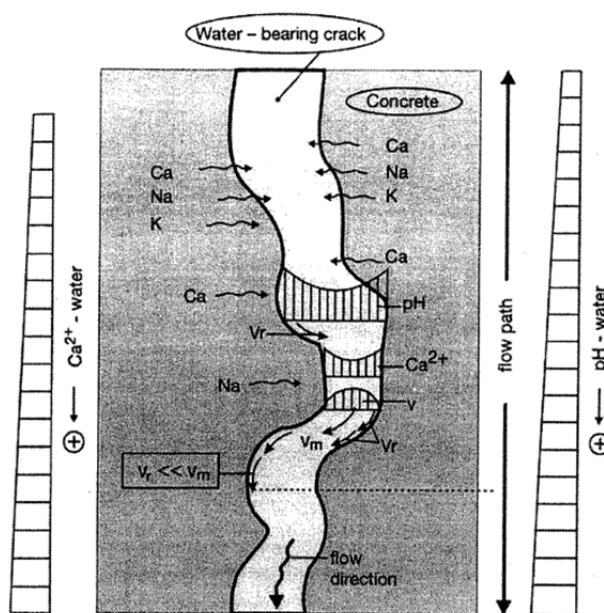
コンクリートのひび割れに侵入した水の状況[2.20]
